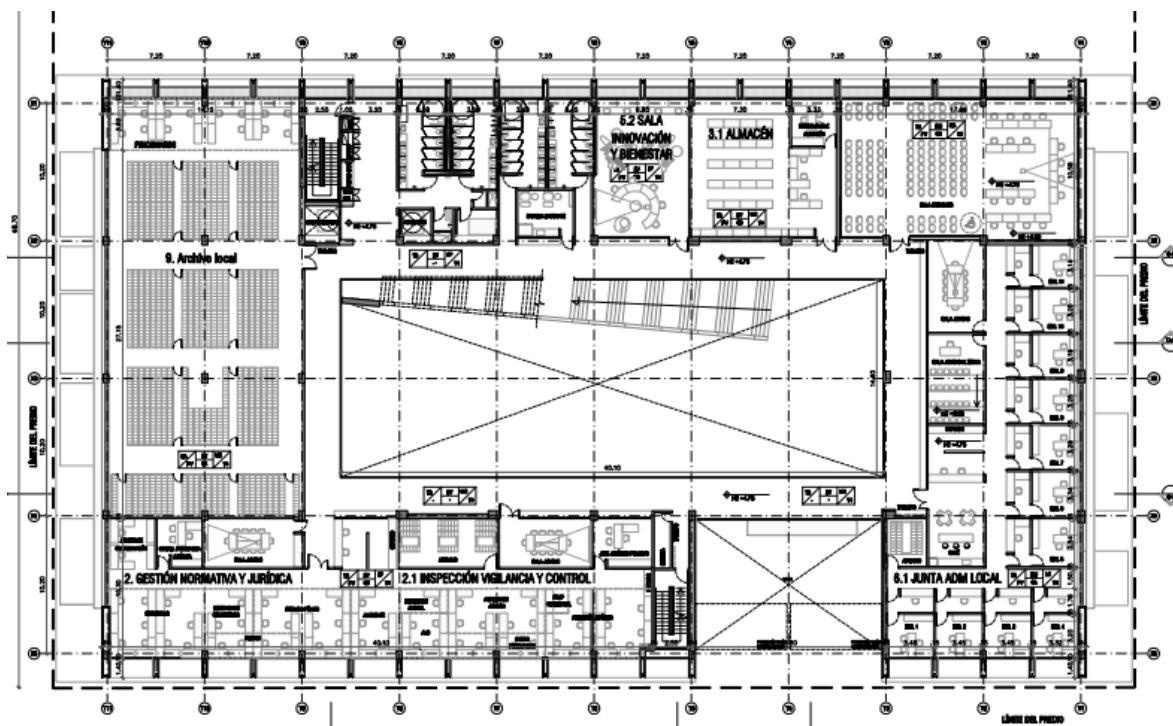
Planta piso 2. Fuente: Planos arquitectónicos.
